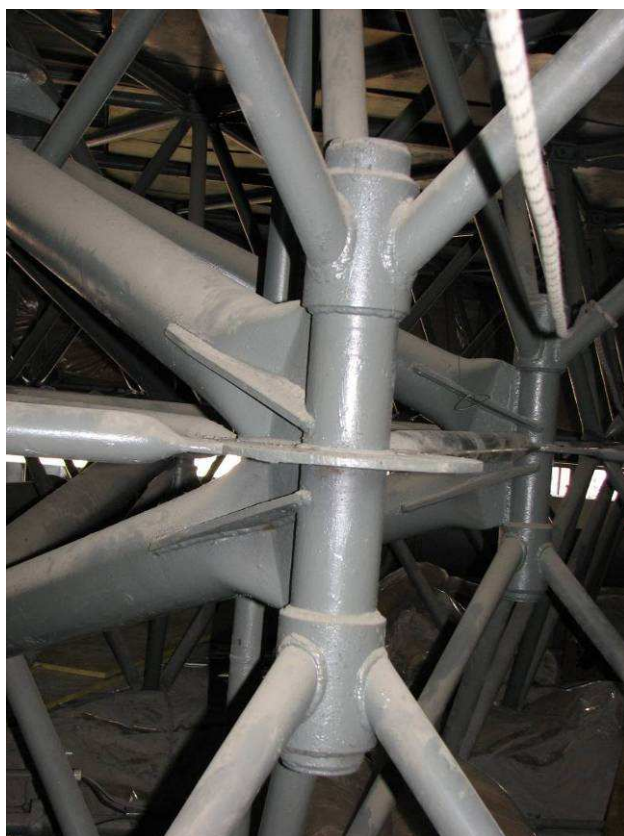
Detail styčnicku u sloupu – výrazné excentrické připojení diagonálních prutů jehlanů.
